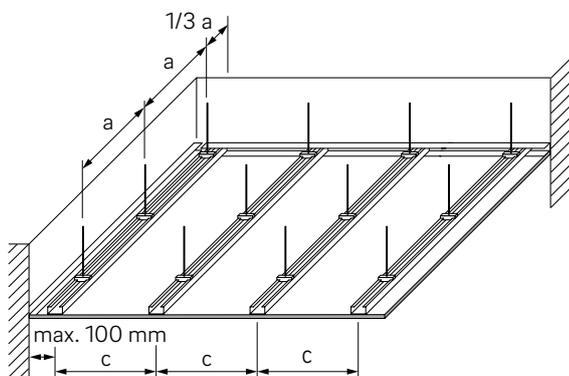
Direkt befestigte Metallunterkonstruktion nach DIN 18181
